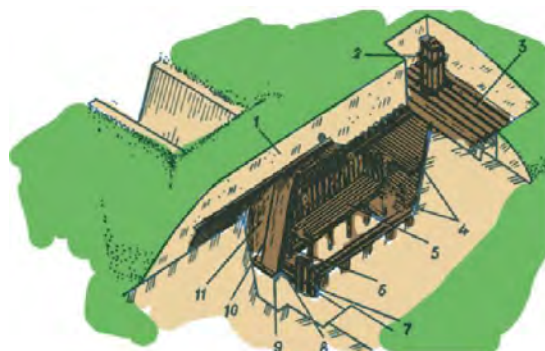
Бліндаж безврубної конструкції з лісоматеріалу на відділення (скіпаж): 1 – перекрита ділянка траншеї; 2 – вентиляційний короб; 3 – накат; 4 – нари; 5 – місце для сидіння; 6 – піч із місцевих матеріалів; 7 – стояк входу; 8 – дверний щит; 9 – привантажувальний елемент завіси; 10 – тяги з 2-міліметрового відпаленого дроту; 11 – герметизувальна завіса
